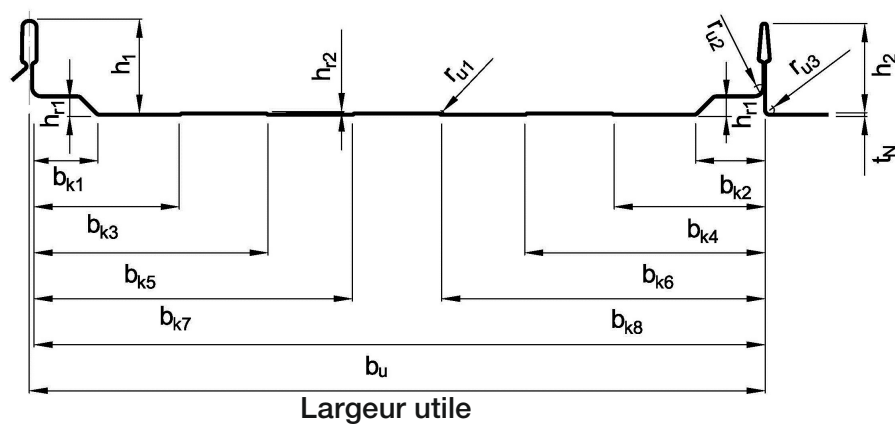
Section transversale des profilés à joint debout - type 1
